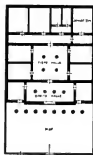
Grundriß des Palastes Amenophis' IV., nach den Abb. 48 rekonstruiert.
